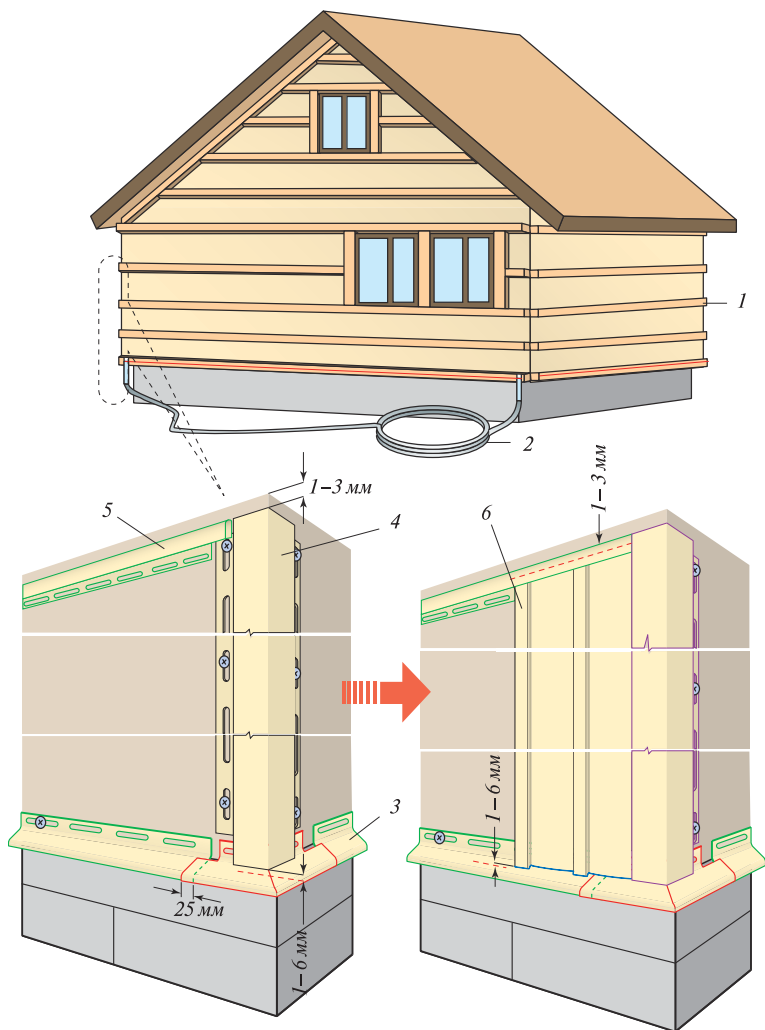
Схема монтажа вертикального сайдинга: 1 – горизонтальная обрешетка; 2 – водяной уровень; 3 – отлив Дёке; 4 – угловой профиль; 5 – J-профиль; 6 – вертикальный сайдинг (неперфорированный соффит)
